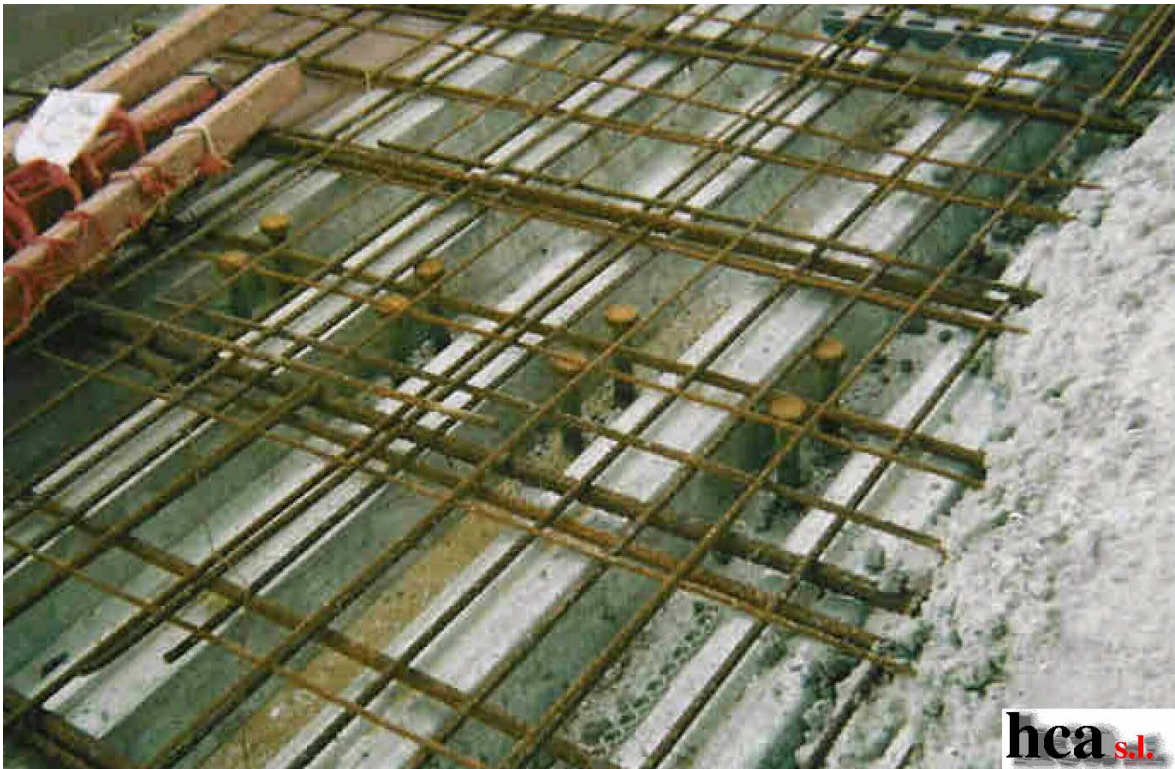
Forjado mixto de chapa grecada colaborante
